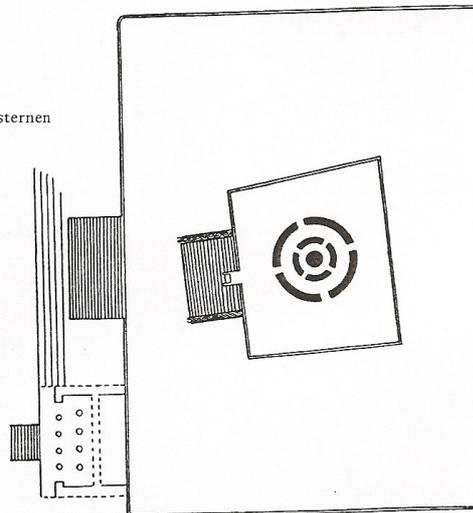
Caracol. Grundriss. Nach Maudslay III, Pl.
